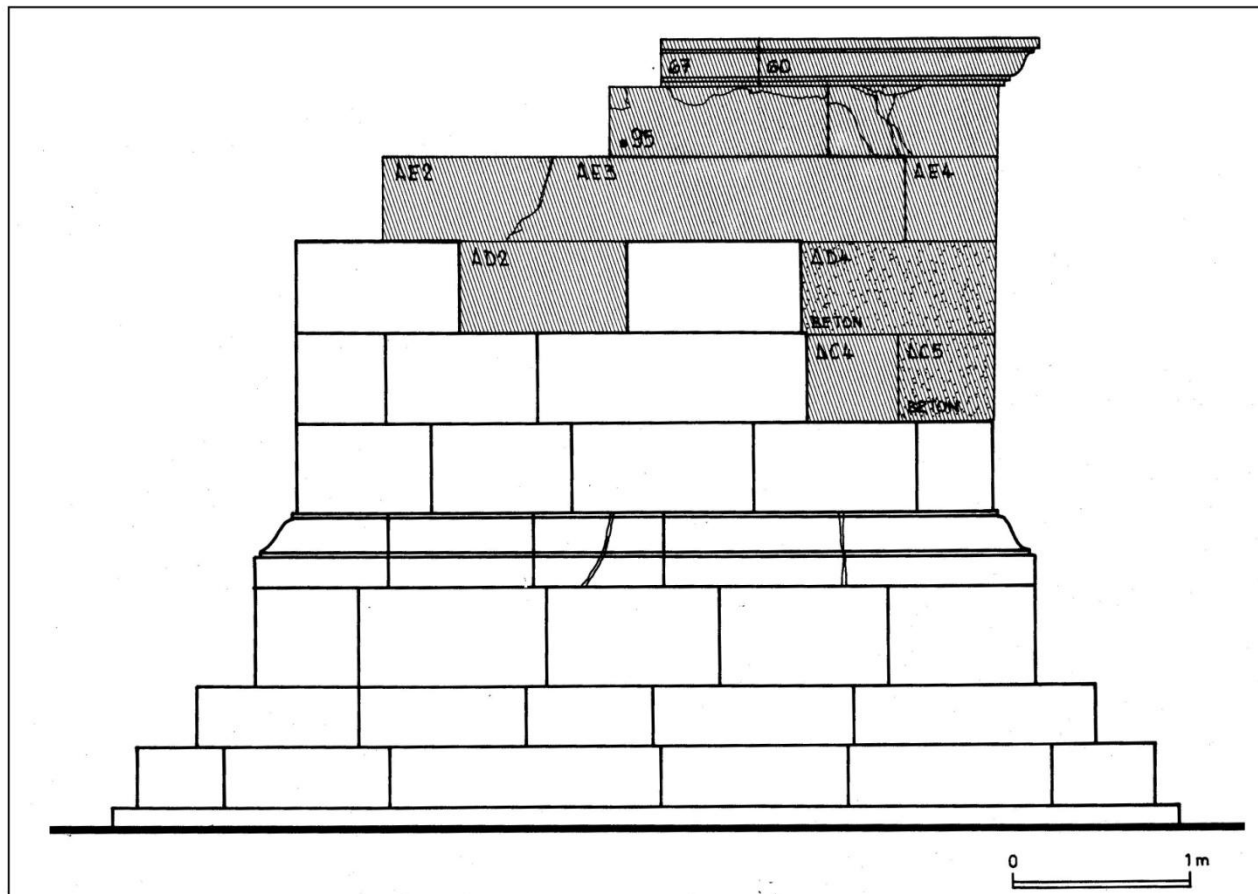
Façade nord du mausolée. En hachuré : pierres remontées. En hachuré+points : béton de gravier 3/8.
